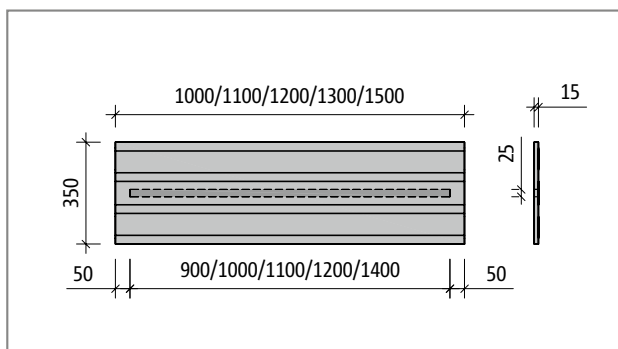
Schöck Tronsole® tipo B-V1-L...-B350, pianta del prodotto
